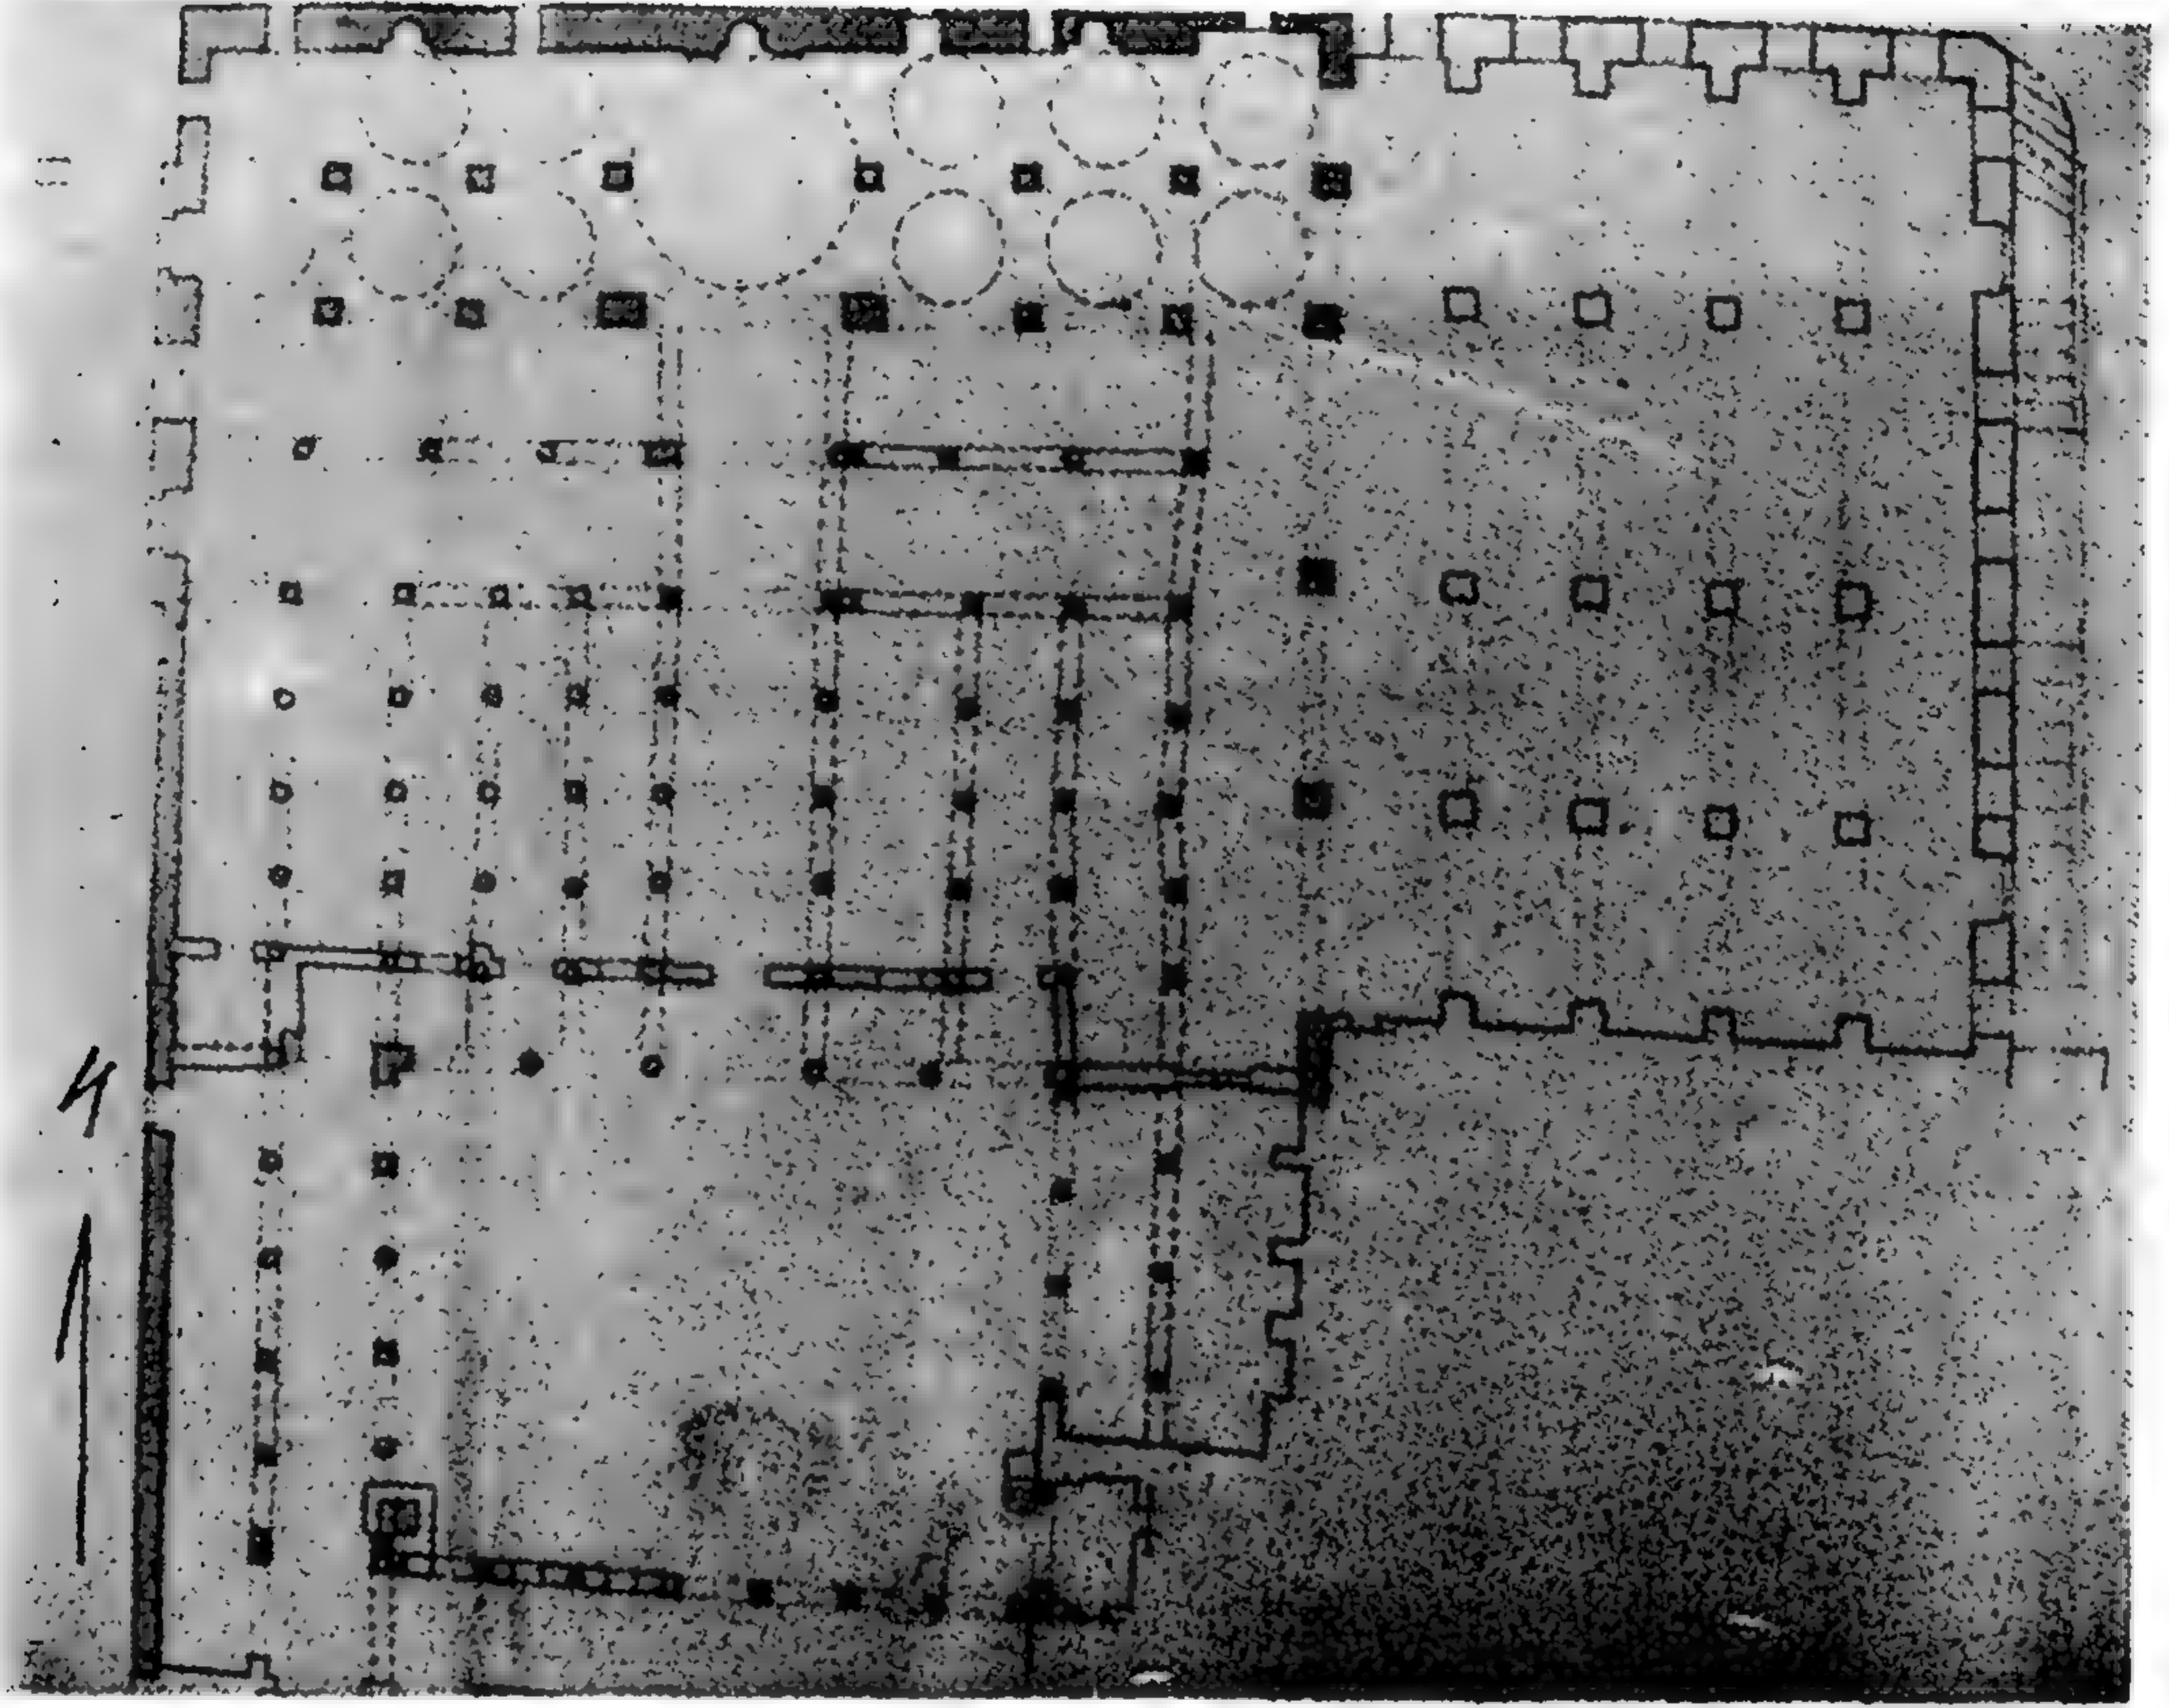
المسقط الأفقي للجامع الكبير بشبام كوكبان Barbara Finister
